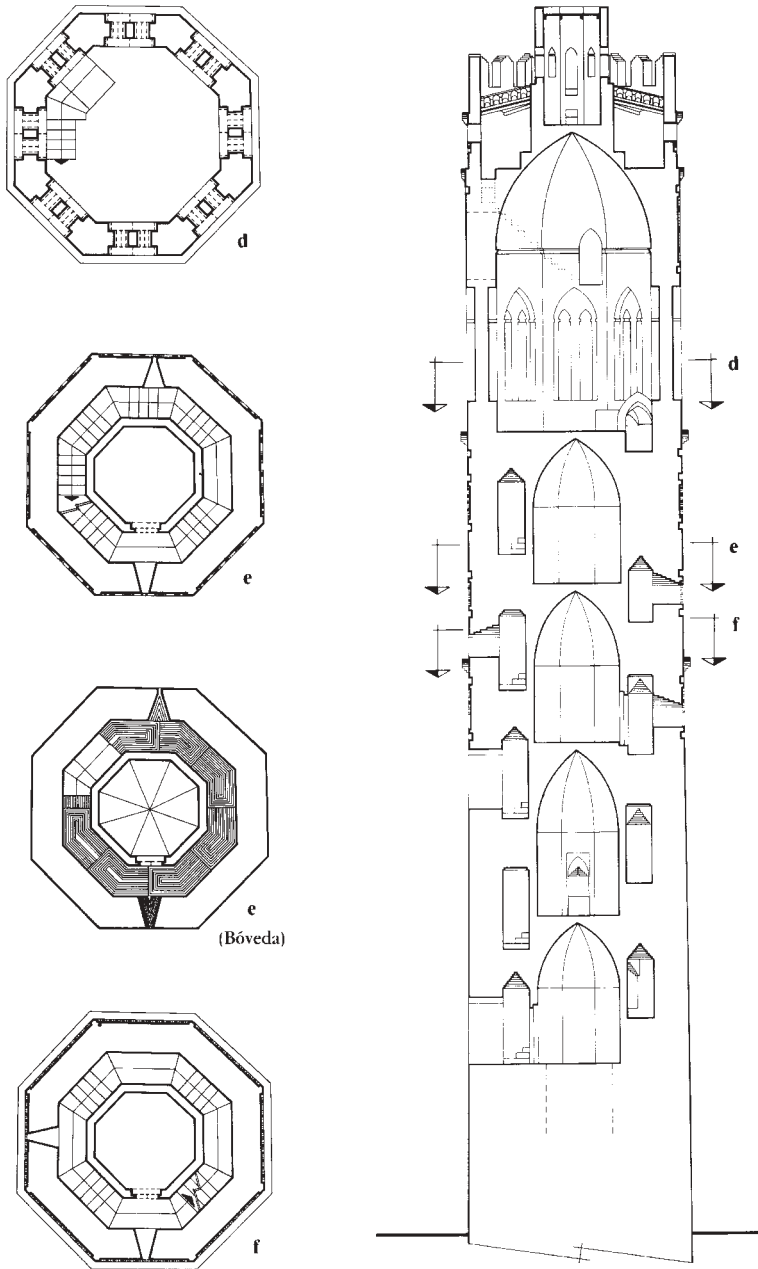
Torre de Santa María de Tauste. Plantas y sección.
